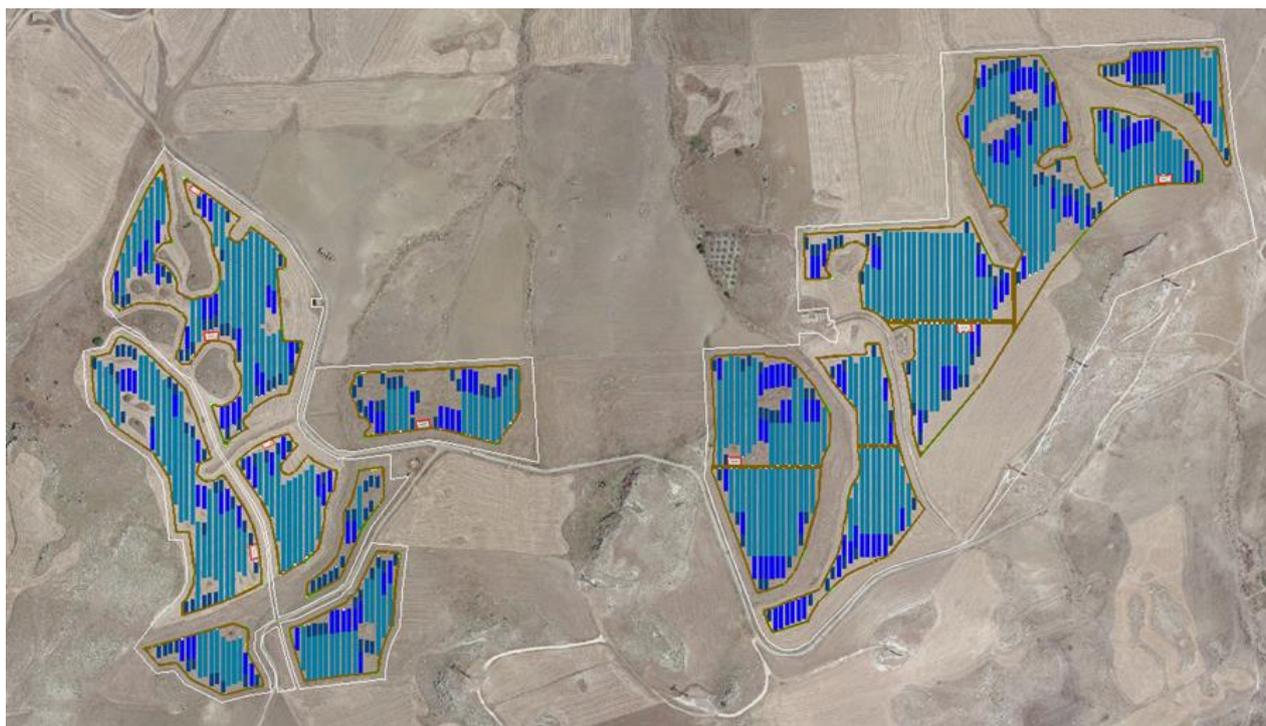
LAYOUT PLANIMETRICO IMPIANTO – ESTRATTO ELABORATO CARTOGRAFICO MINEO-PDT05
